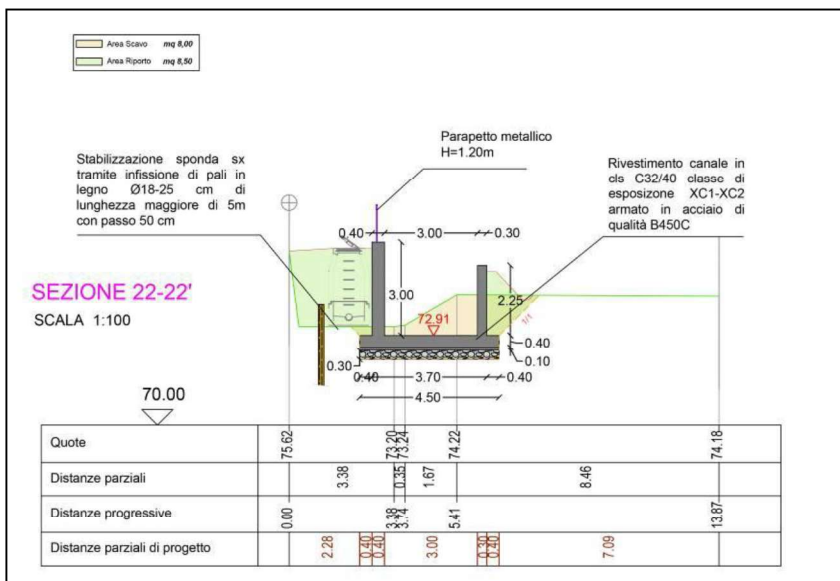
SEZIONE ESEMPLIFICATIVA DEL PROGETTO DEL LOTTO I.
